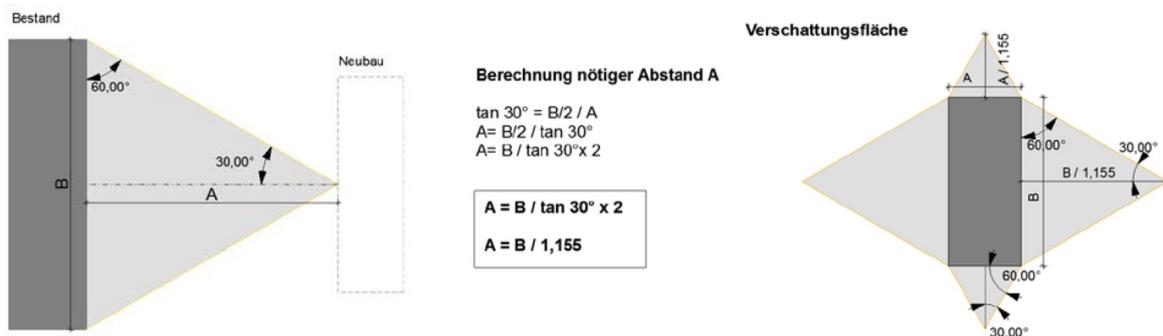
30° Verschwenkung - resultierende Abstandsfläche, Ermittlung und Grundrissfigur, eigene Ausarbeitung: Pirstinger, Majcen, Raudaschl
